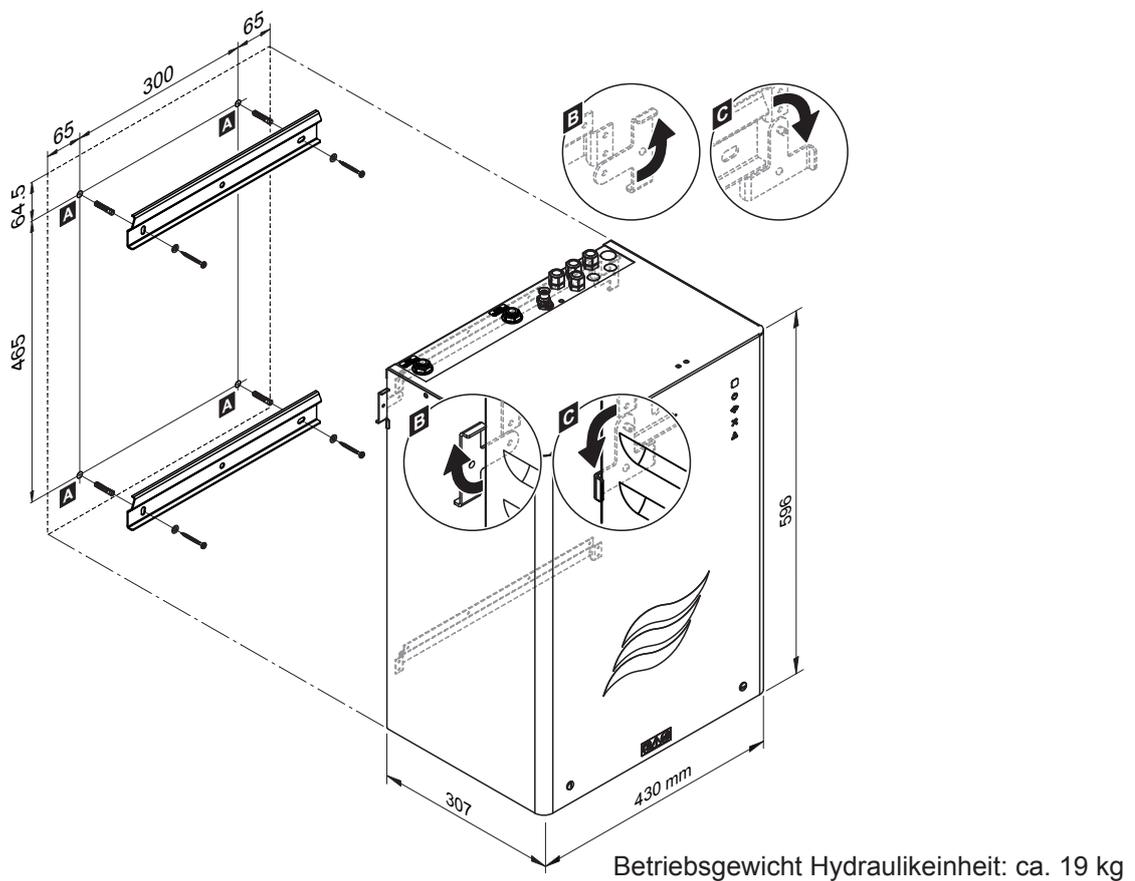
Montage der Hydraulikeinheit (Dimensionen in mm)
